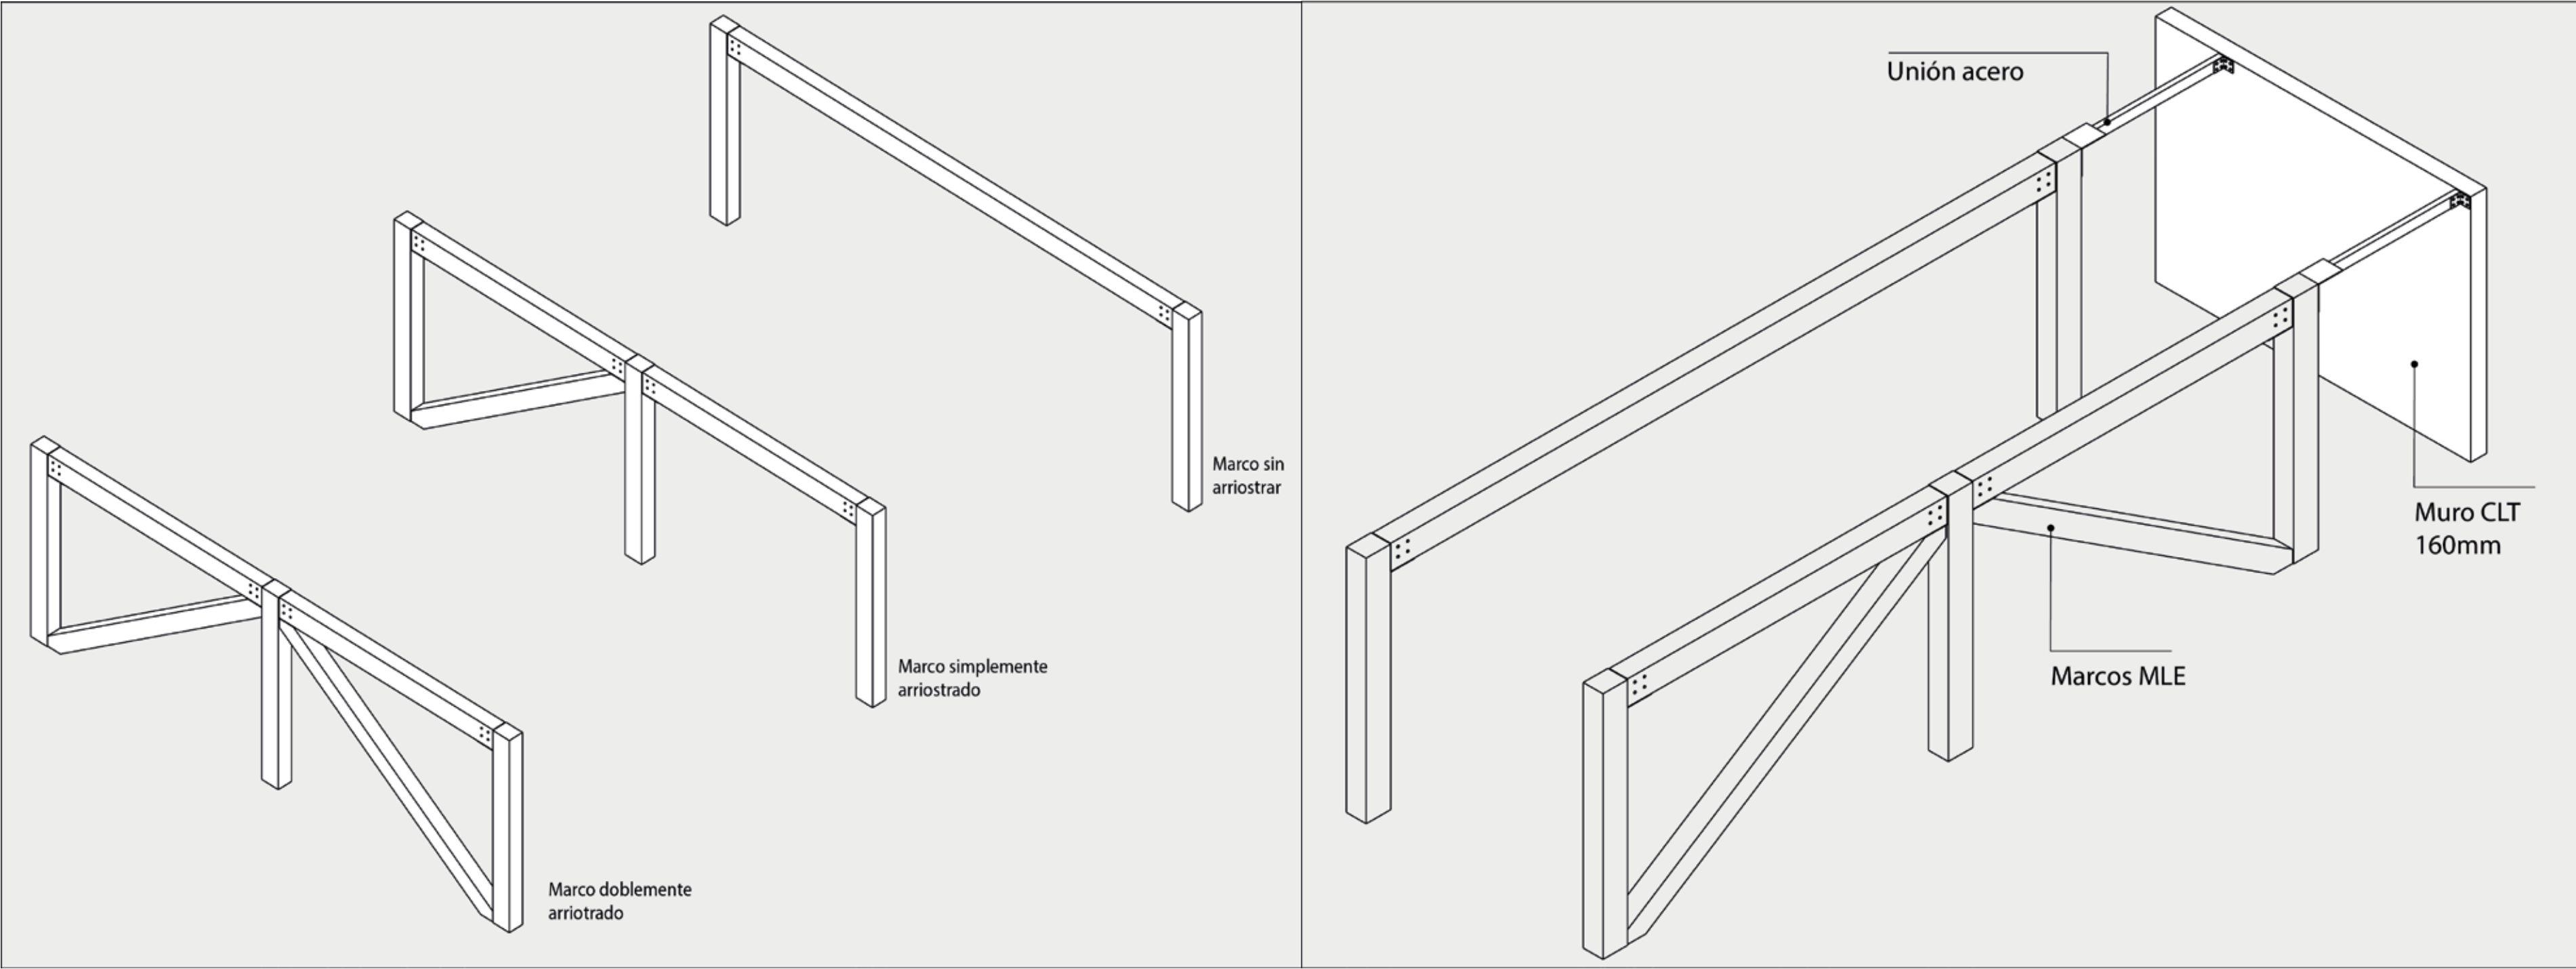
y 8: Tipologías de poste-viga utilizados y sistema estructural mixto
